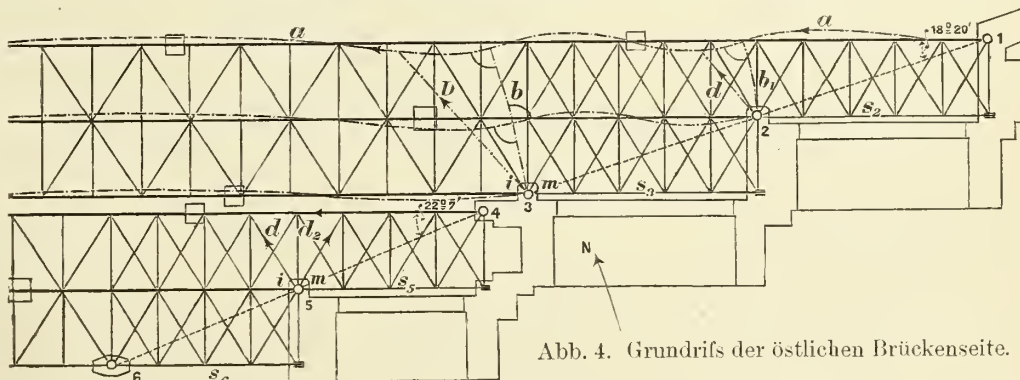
Grundriss der östlichen Brückenseite.
